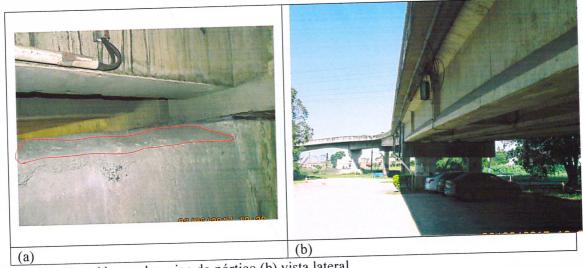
(a) resíduos sobre viga do pórtico (b) vista lateral
